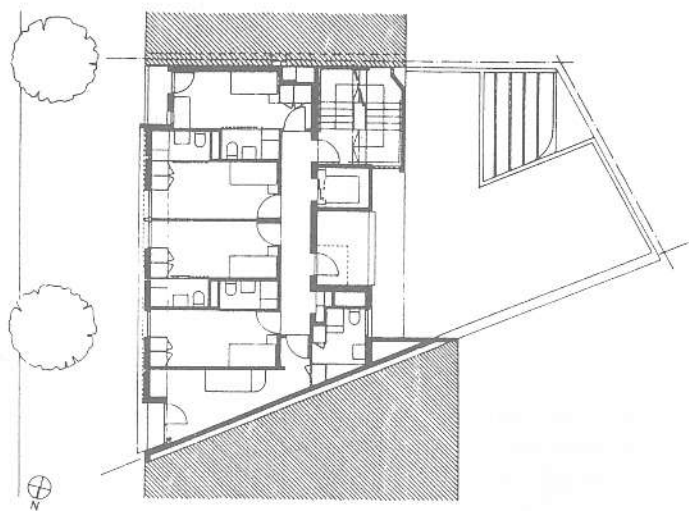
O. Chaslin, "Résidence meublée" in rue des Pyrénées a Parigi: pianta piano tipo.
